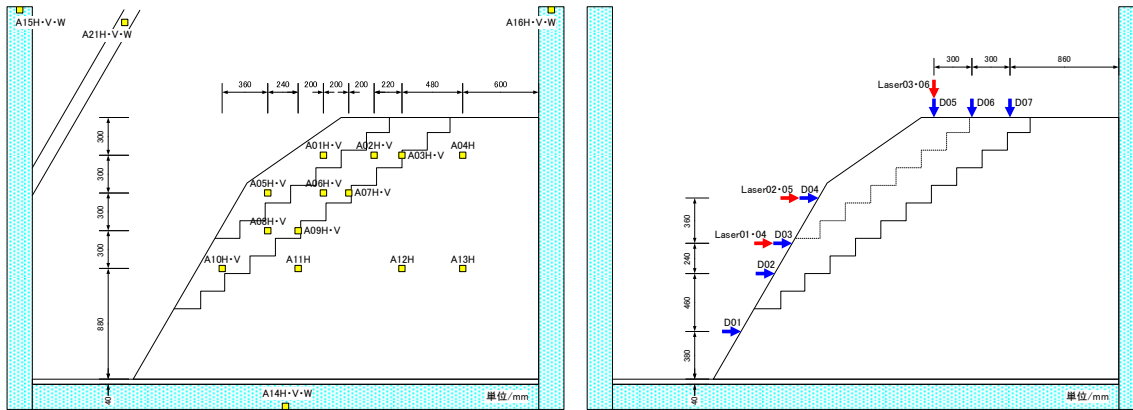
ケース 10 モデル形状図 (左：加速度配置図、右：変位計配置図)
